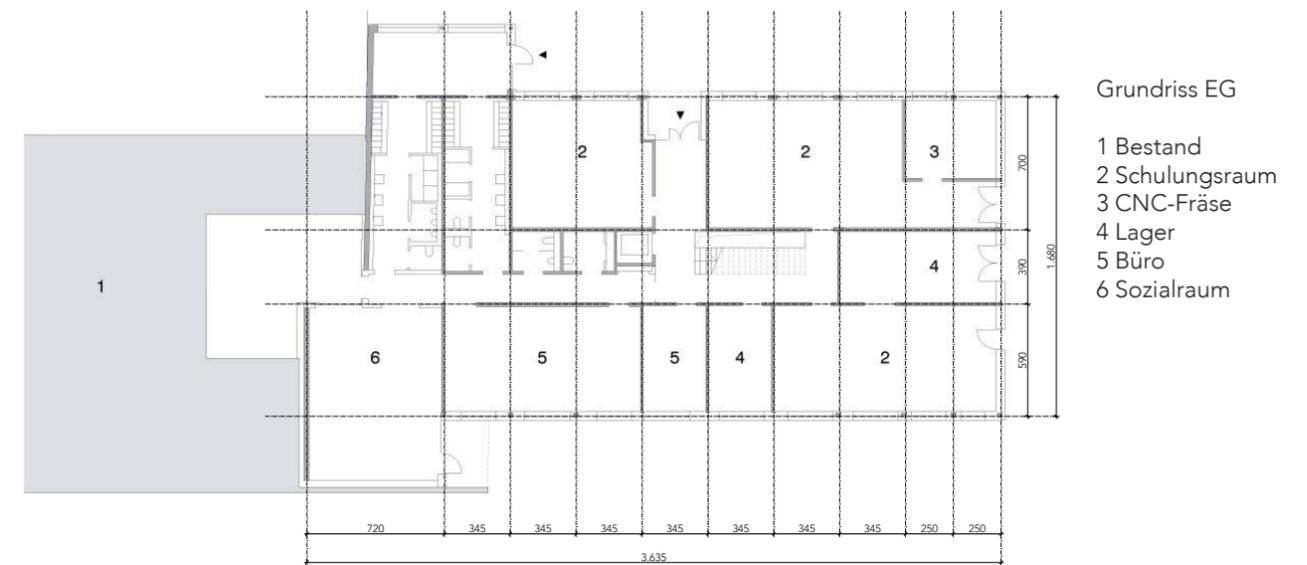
Grundriss Erdgeschoss, <http://www.magk.at/hdl>
